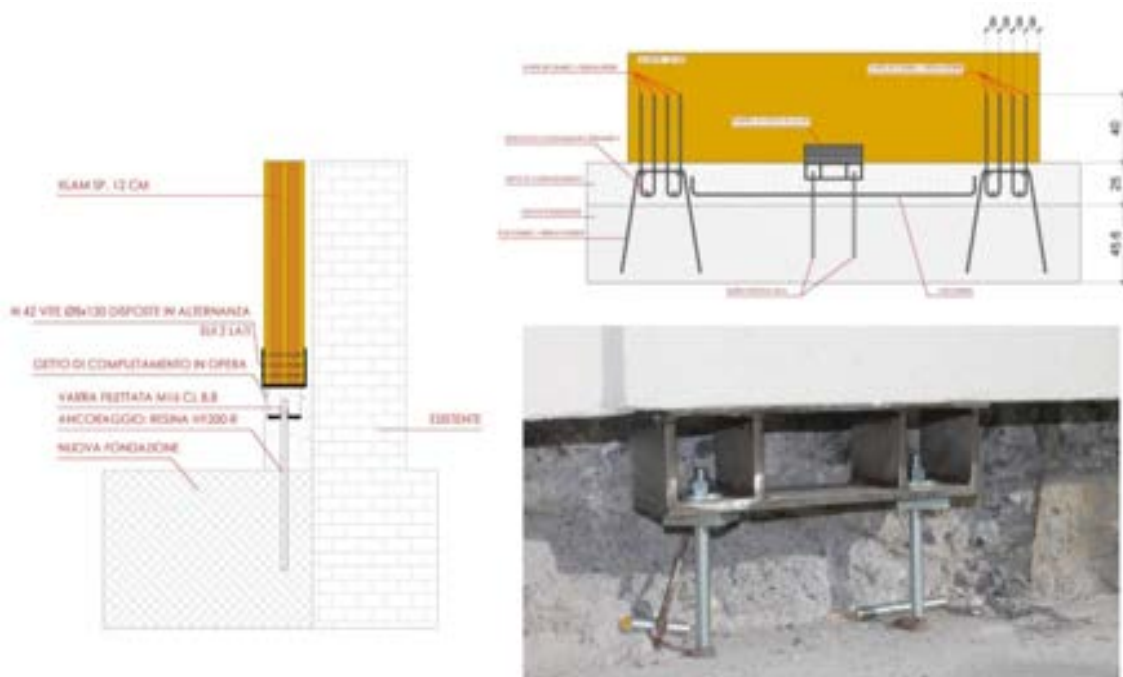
Ancoraggio in fondazione (sistema Rhinoceros-Wall - Wood Beton)
